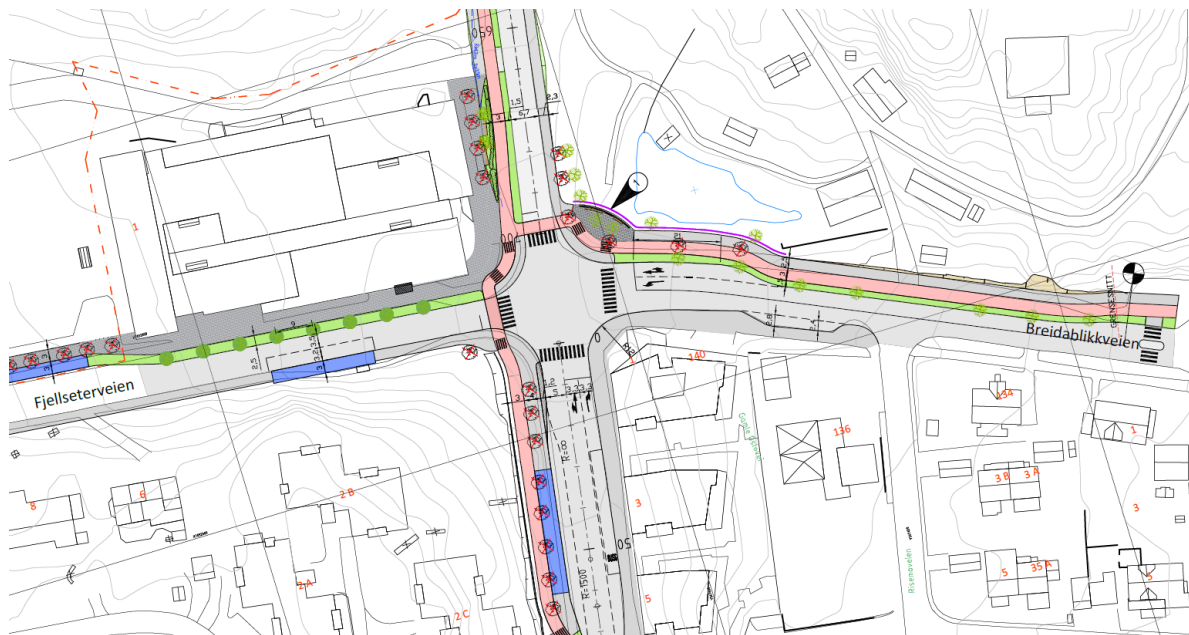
Planforslaget legger opp til etablering av 14 nye langsgående parkeringsplasser langs fortauet.
